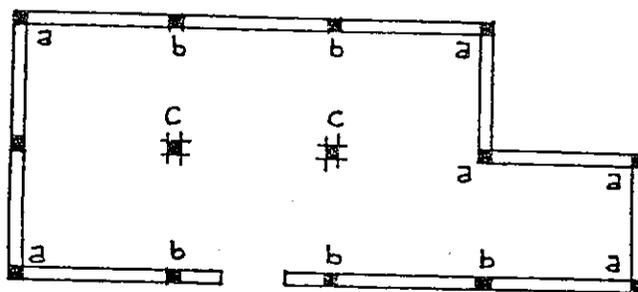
Schéma en plan montrant les différents emplacements des poteaux
